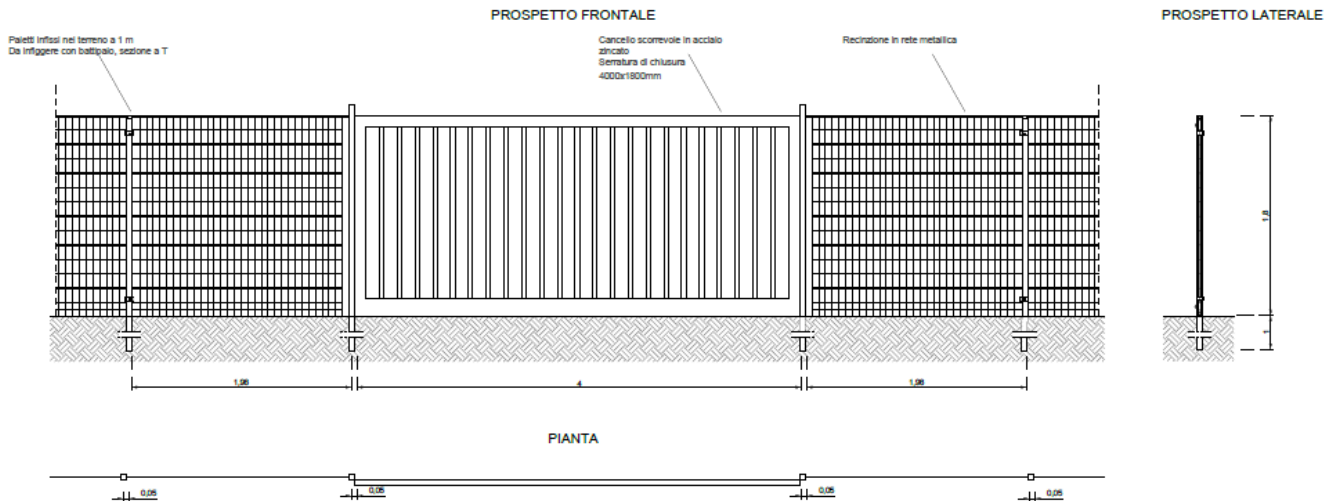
Prospetto, pianta e sezione del cancello e della recinzione
